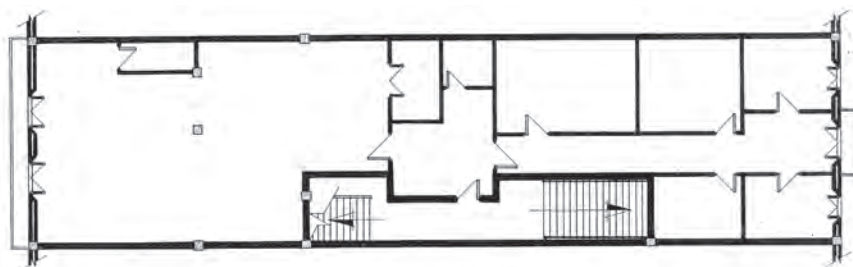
18. 1989 PLANTA PRIMERA TRAS REFORMA
